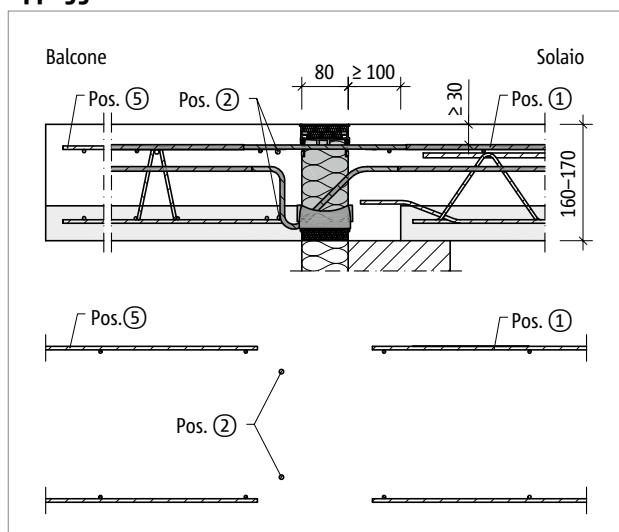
Schöck Isokorb® T tipo K-F: armatura in opera con spessore soletta del balcone $h = 160-170$ mm
